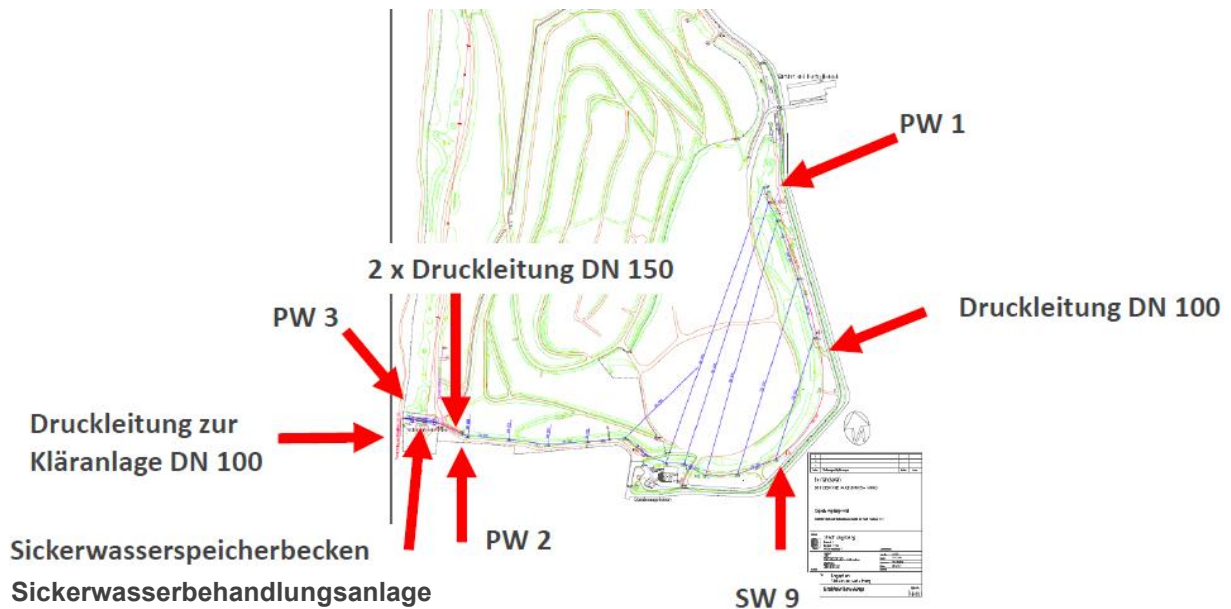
Lageplan Sickerwassersystem (aus Bestand Sickerleitungen 2001)
